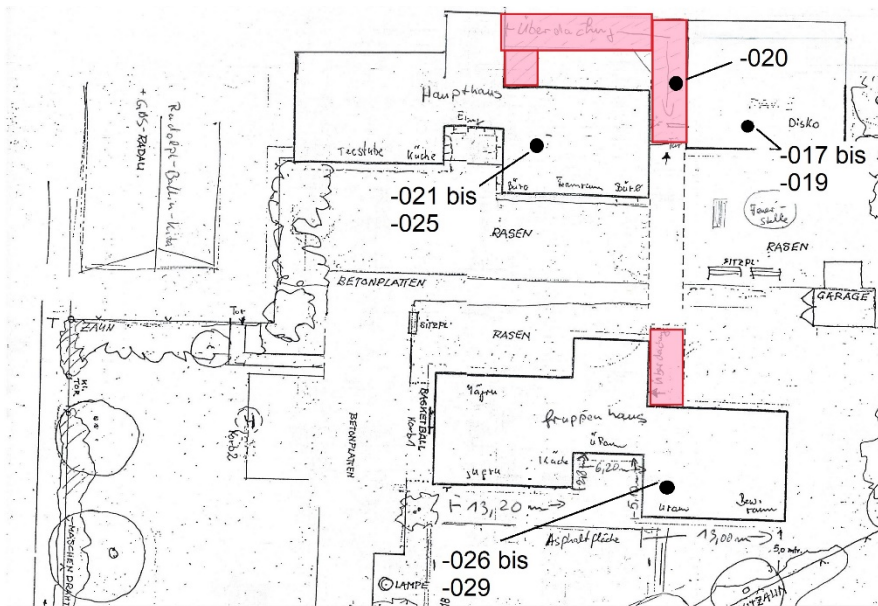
Übersichtsskizze der Gebäude, Hauptgebäude (Haupthaus), südliche Gebäude (Gruppenhaus), Veranstaltungsgebäude (Disco) mit eingezeichneten Dachöffnungen und den markierten Bereichen der asbesthaltigen Dachpappe (rote Umrandung).
